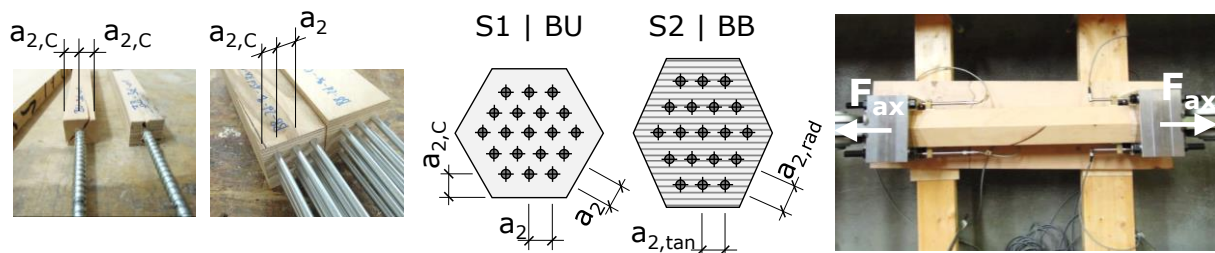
Einschraubprüfungen: Einzelschrauben und Schraubengruppen (links); Querschnitte und Abstände geprüfter Hirnholzanschlüsse (mittig); Prüfkörper mit beidseitigem Hirnholzanschluss im Prüfgerüst (rechts).
